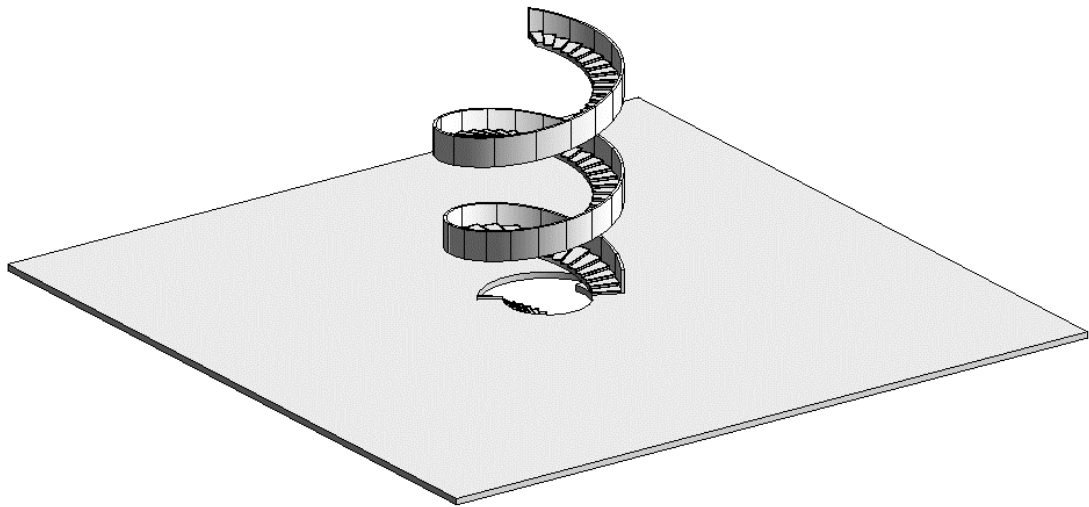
Losa nivel plaza (Vista 3D)
